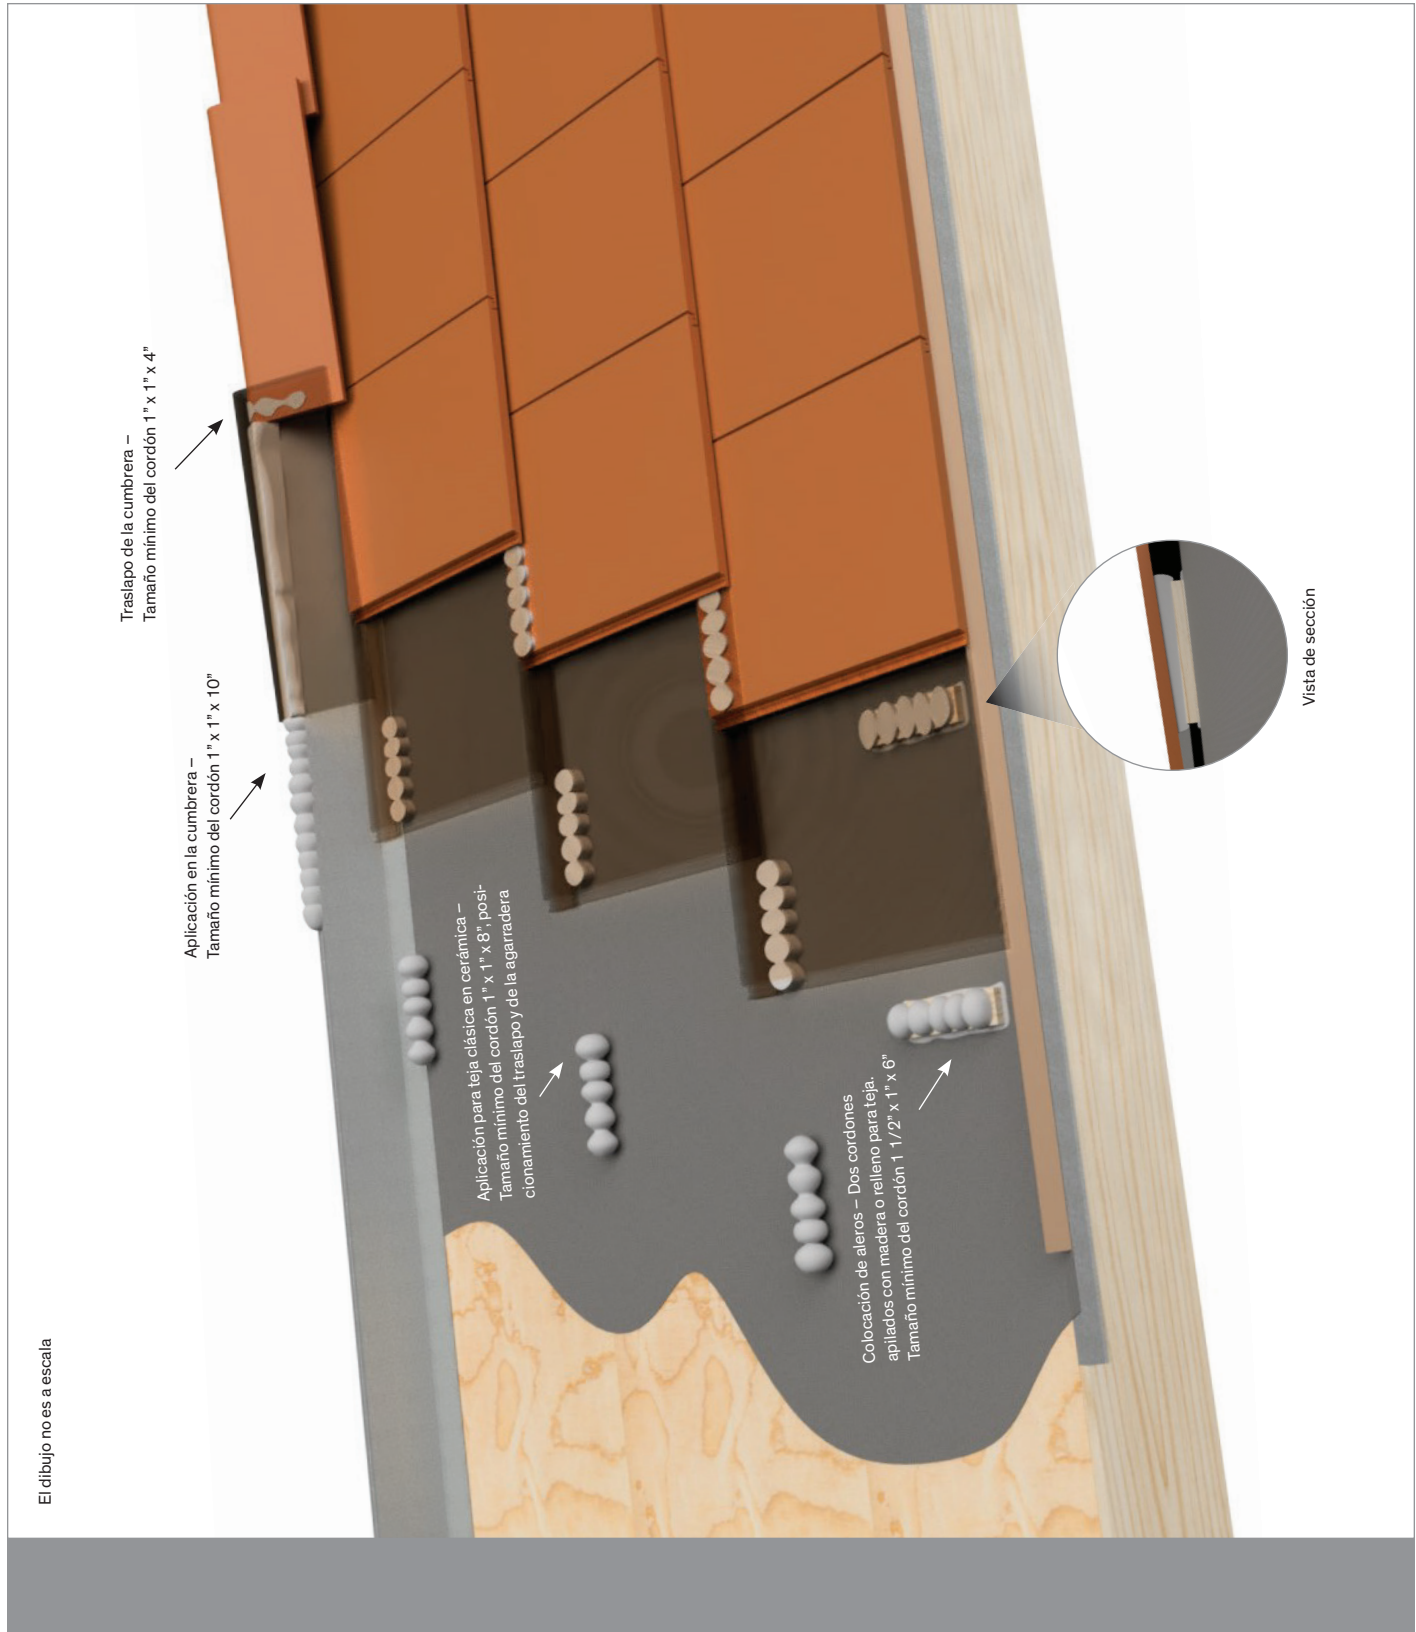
Instalación de tejas de perfil plano, directamente sobre la armazón
